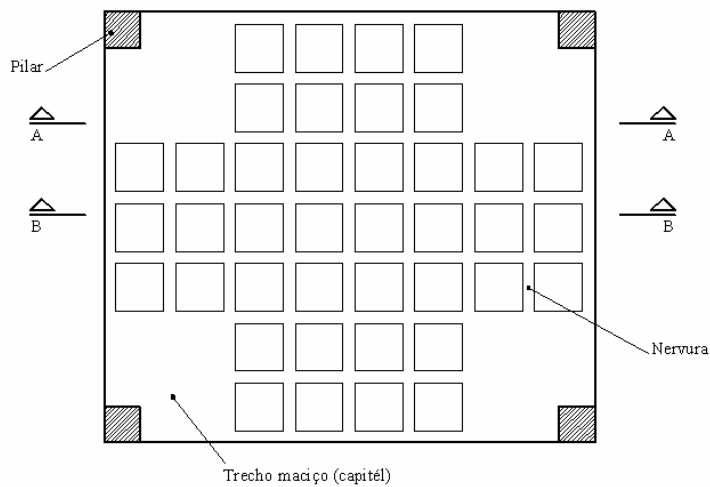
Vista inferior da laje cogumelo nervurada.
